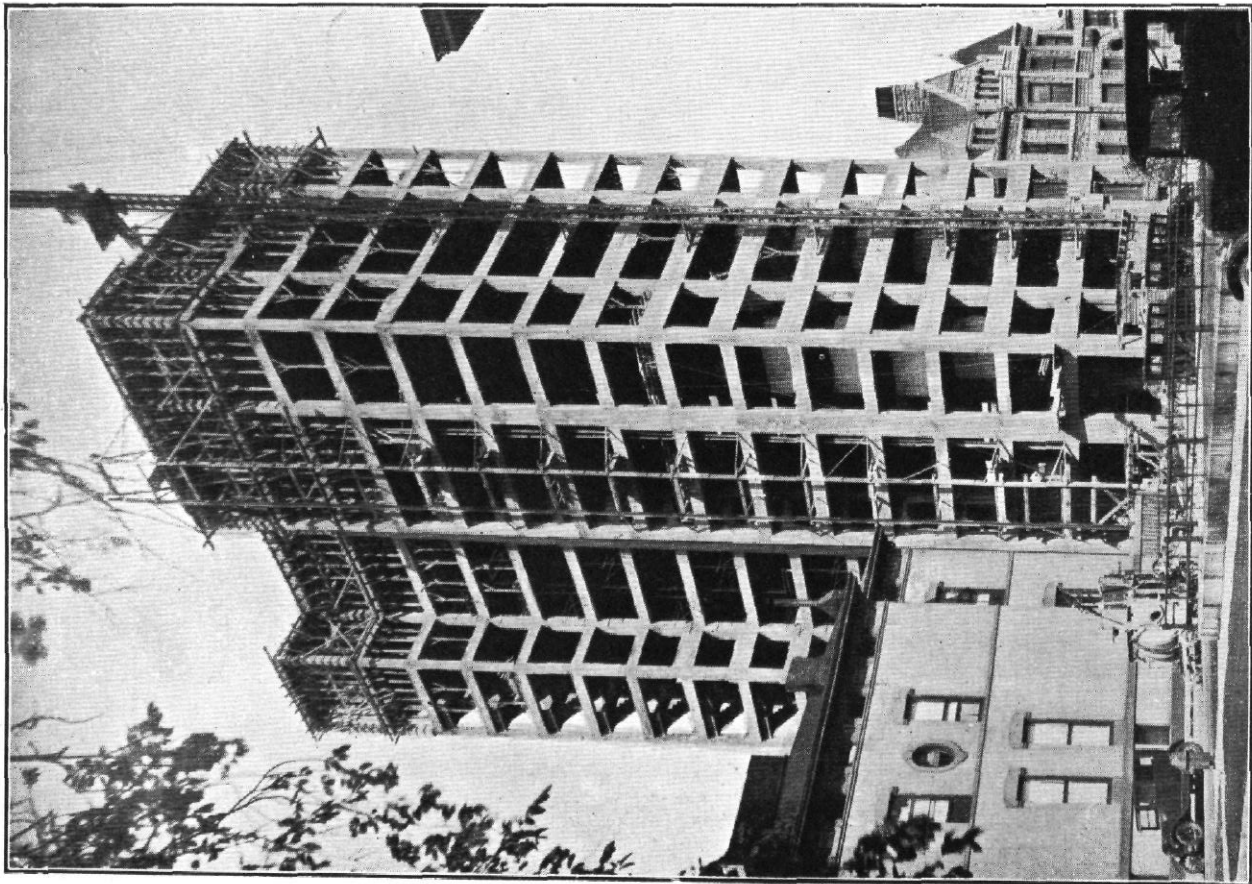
/ Die Tragkonstruktion eines Eisenbetonbaues während der Ausführung
